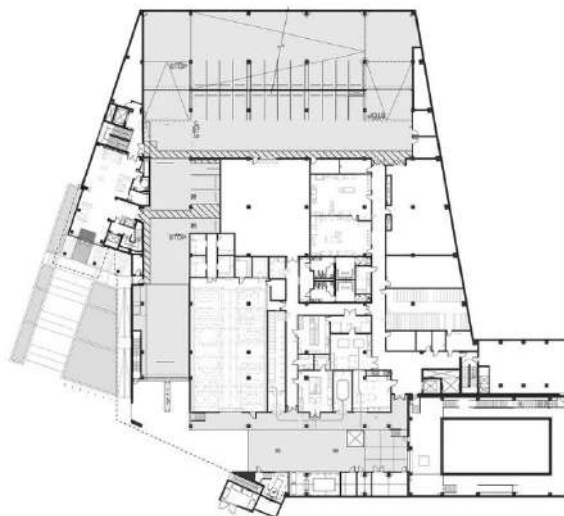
Site Plan NOAA Southwest Fisheries Science Center
